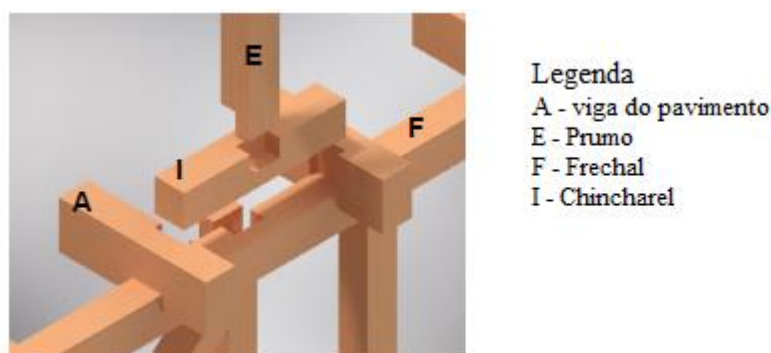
Ligação que assegura a continuidade dos elementos verticais de piso para piso. [9]
